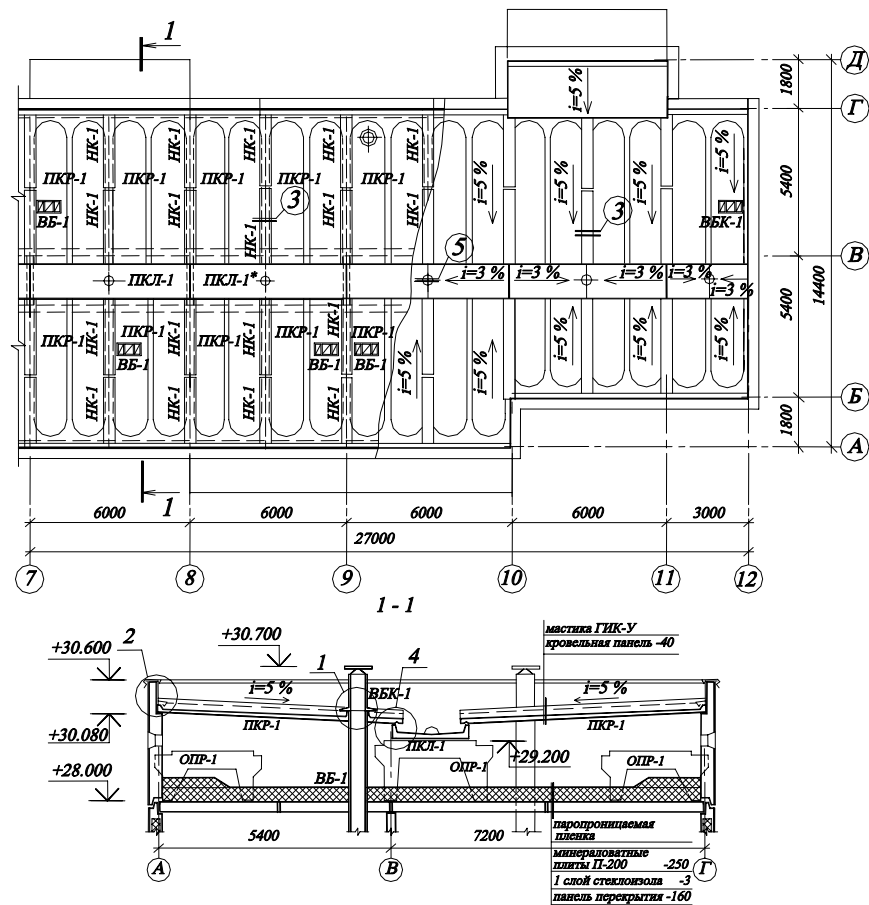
Холодный чердак и безрулонная кровля. План расположения конструкций покрытия и кровли; поперечный разрез. Узлы 1 – 5 см. рис. 15:
